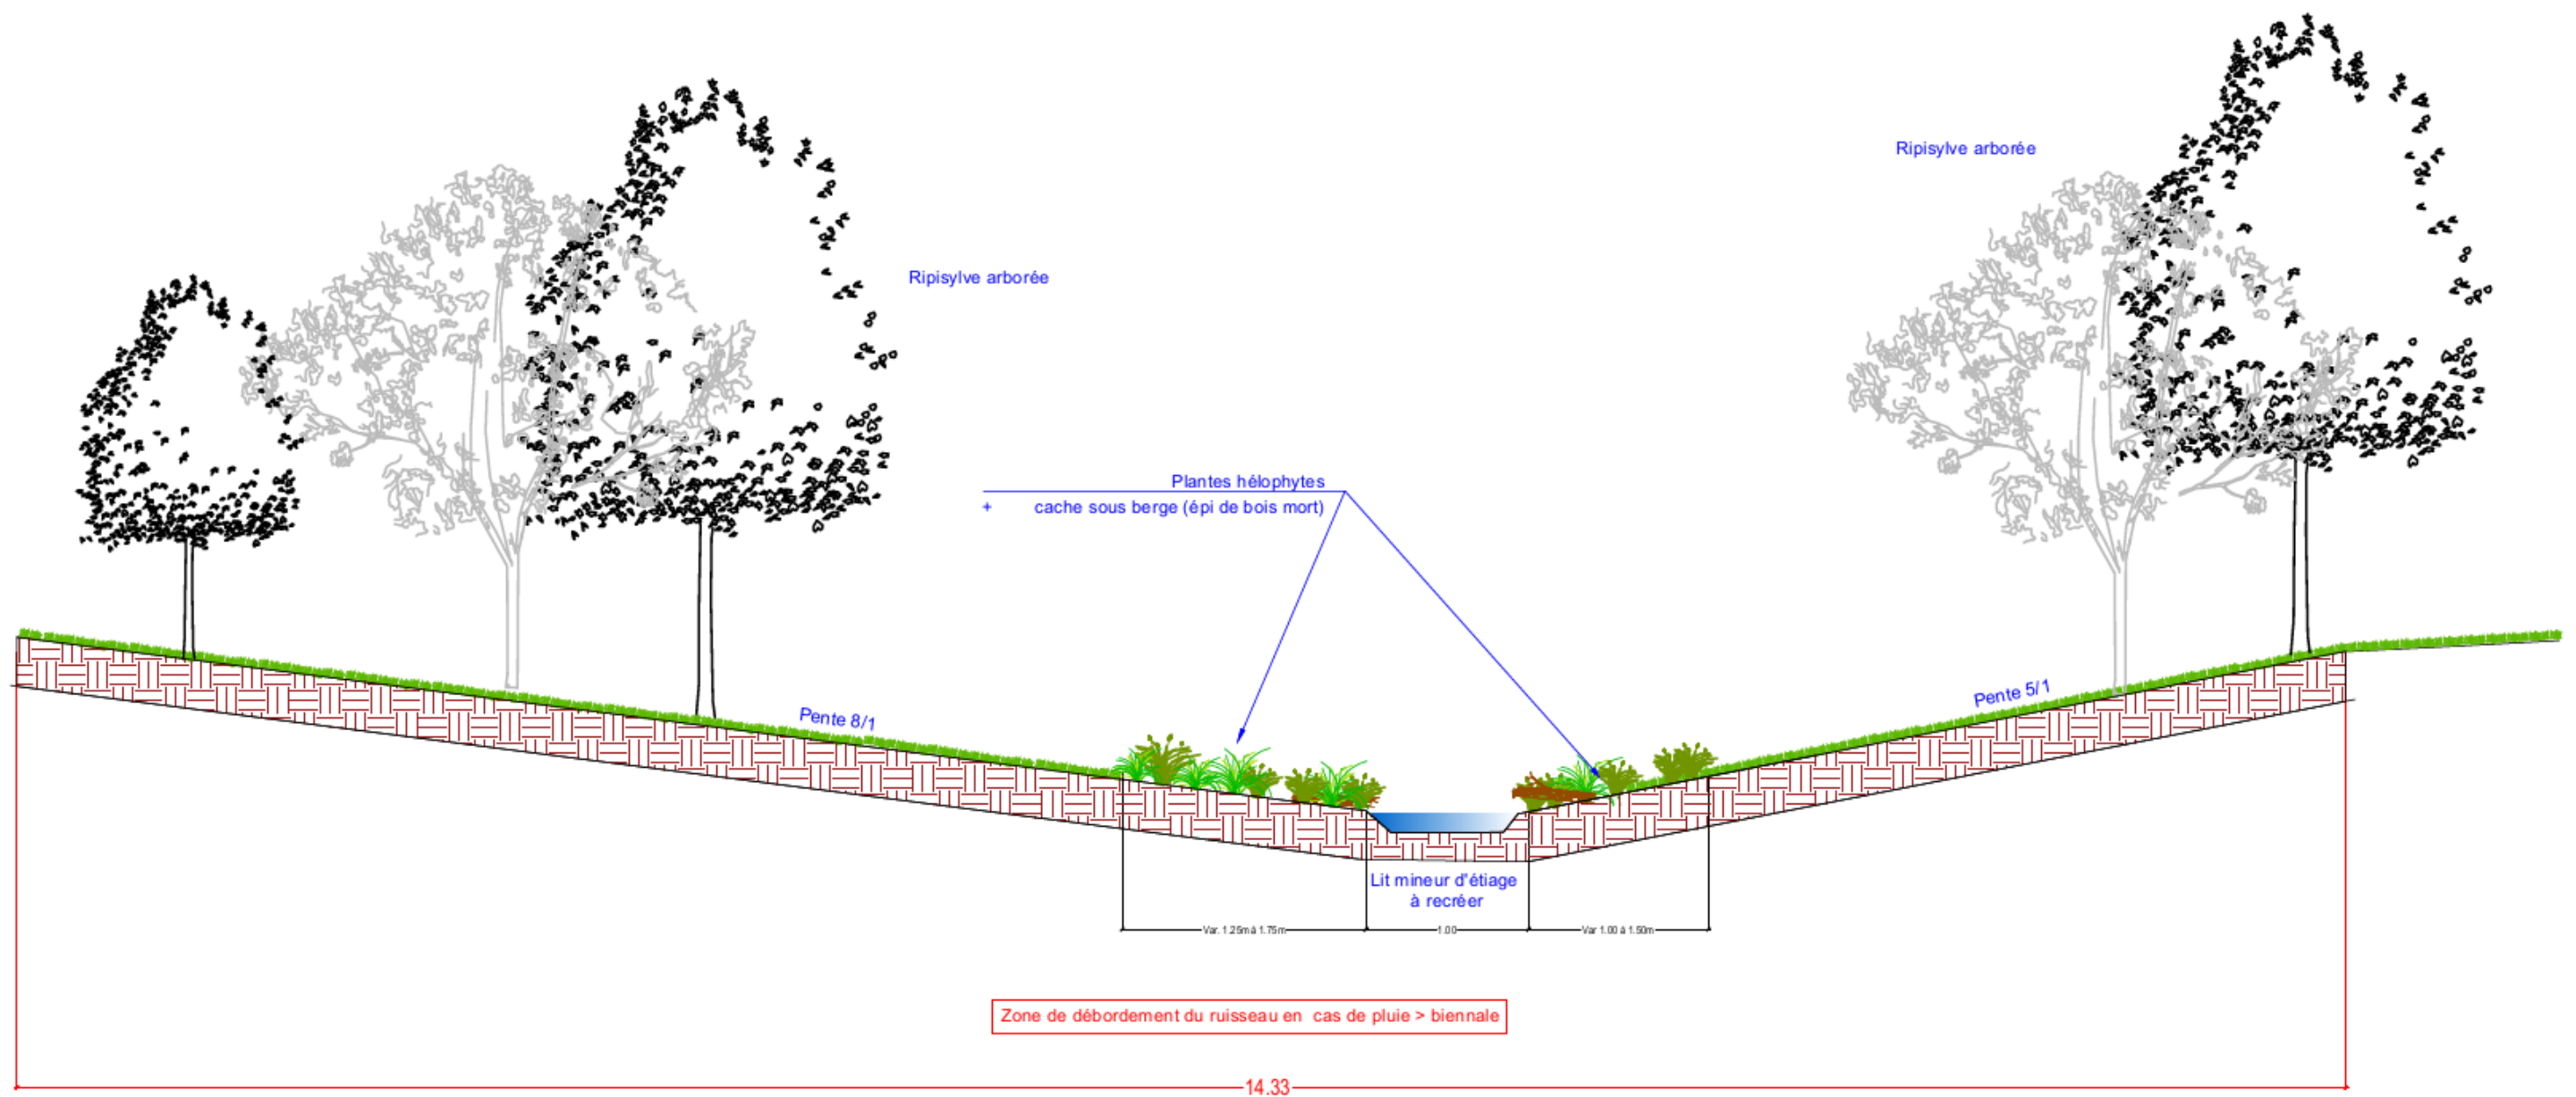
REMEANDRAGE DU RUISSEAU PREVU DANS LE CADRE DU PROJET – COUPE BB'
